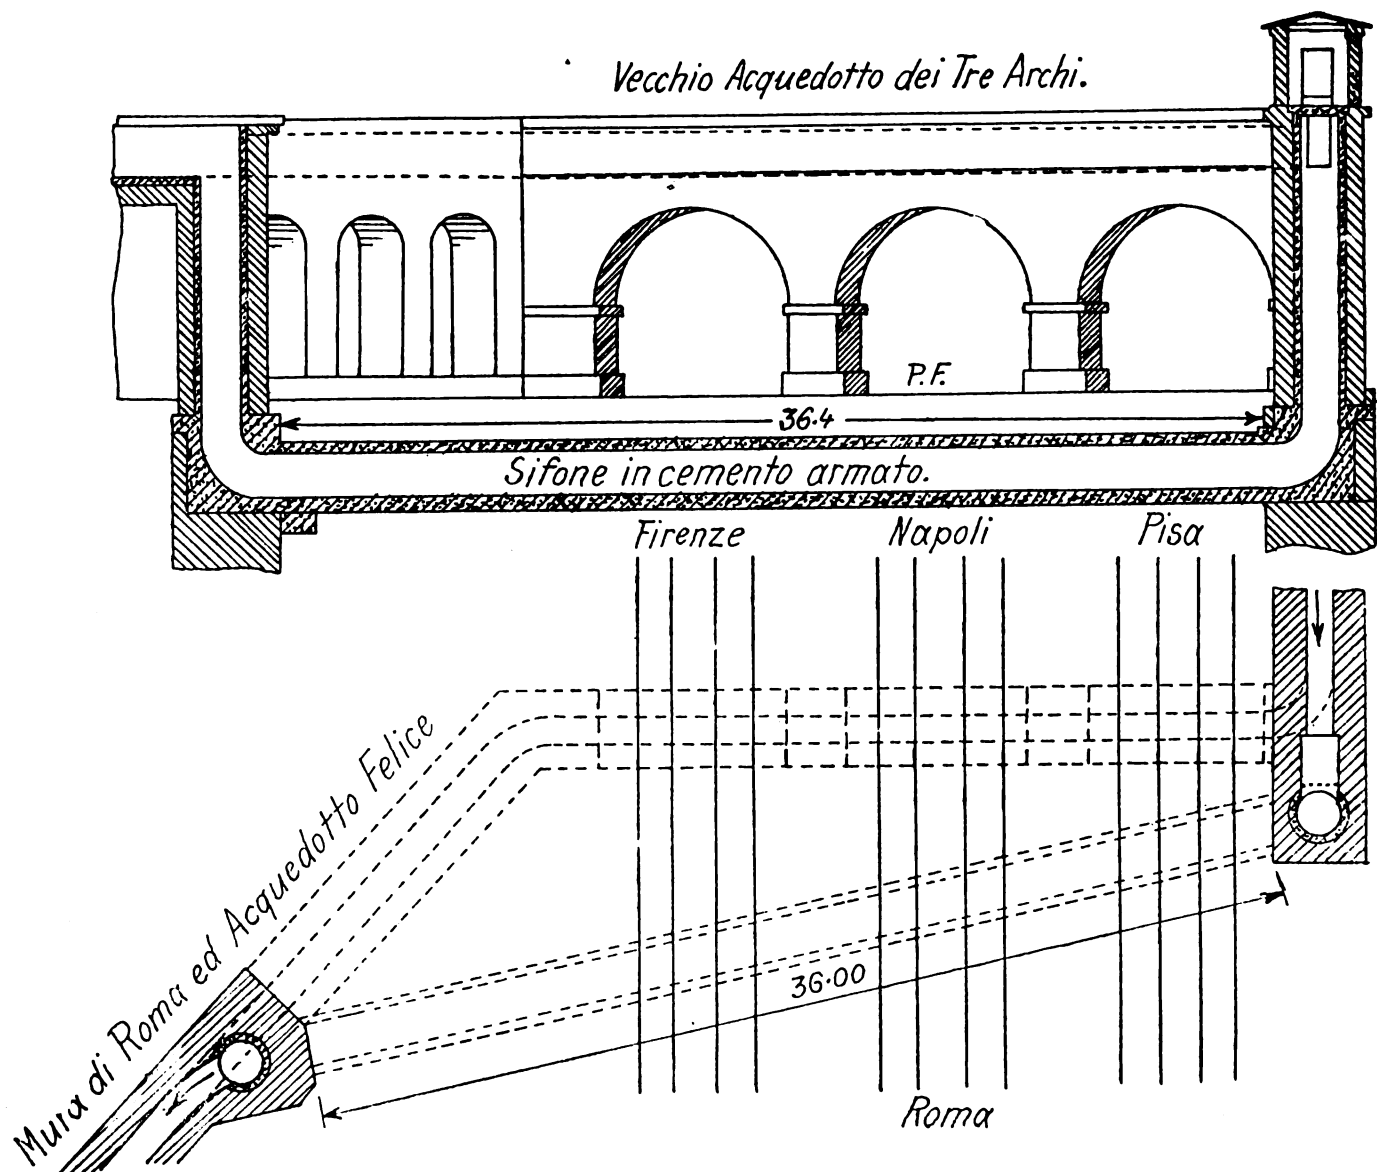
Ponte-canale detto dei « Tre Archi » e sifone in cemento armato. - Sezione e pianta.
